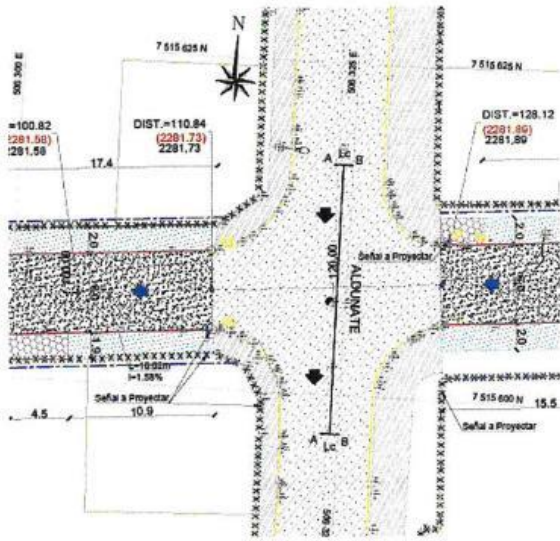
Intersección de calle Javier Carrera con calle Aldunate proyectada, donde se definen límites de carpeta asfáltica por lado oriente y poniente.
